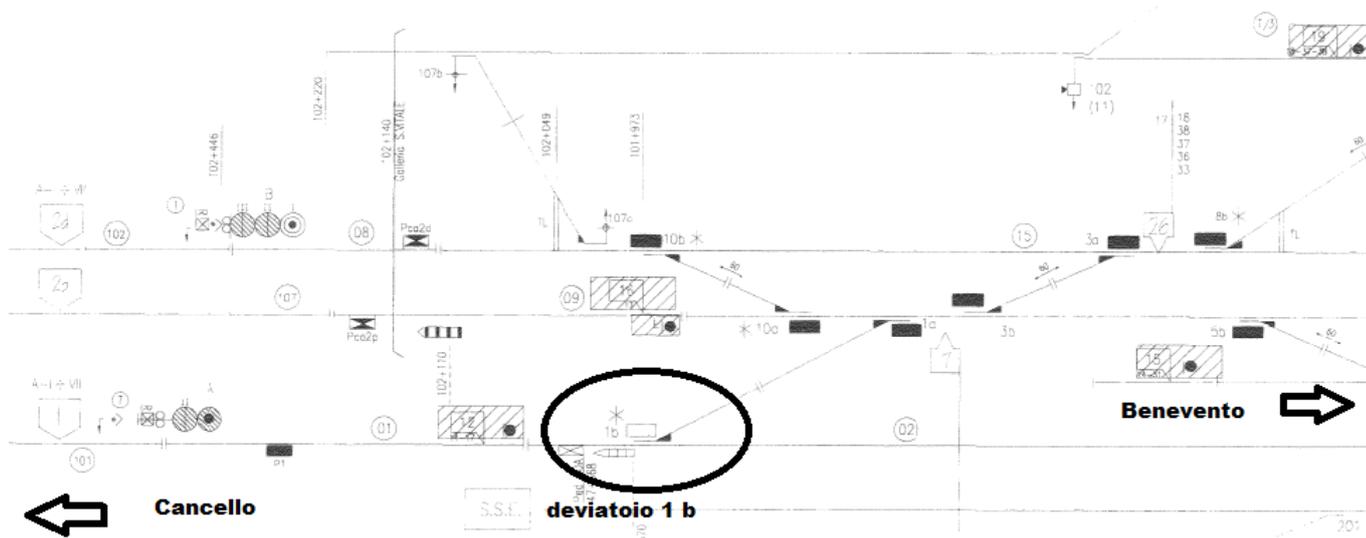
Stralcio piano schematico IS stazione Benevento (fonte RFI)
